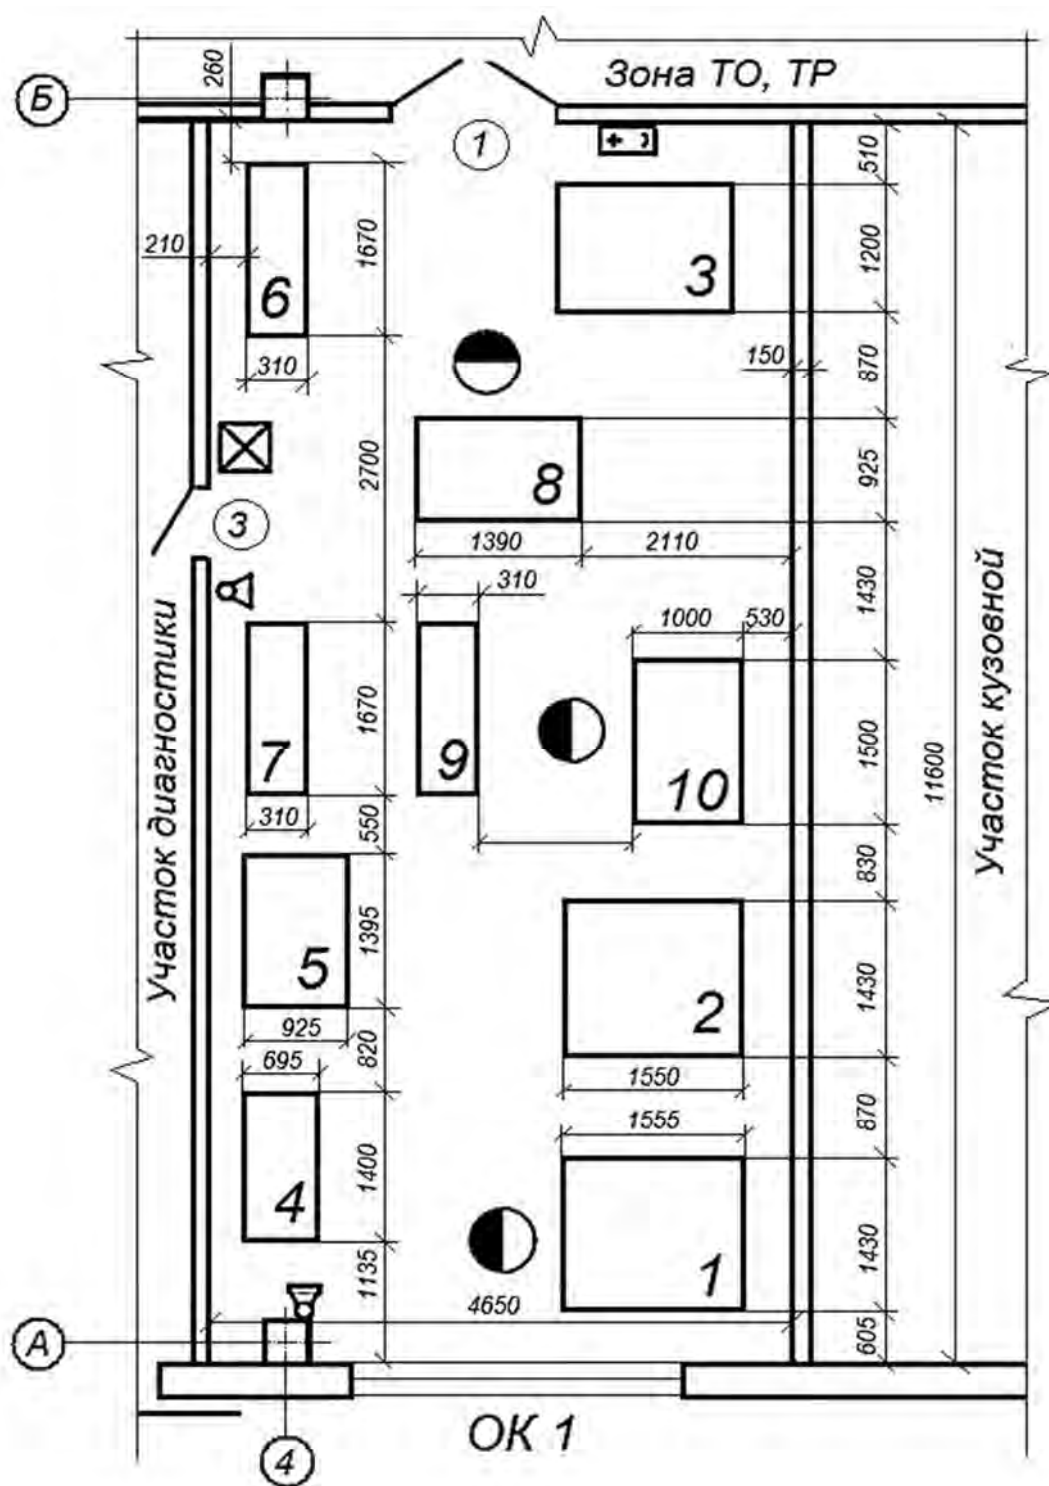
Планировочное решение кузнечно-рессорного участка: 1 – пневматический ковочный молот; 2 – стеллаж для рессорных листов; 3 – подставка для деталей; 4 – верстак для рессорщика на чугунных ножках; 5 – стенд для сборки-разборки рессор; 6 – ванна нейтрализационная; 7 – ванна промывочная; 8 – стенд для испытания рессор; 9 – стенд для рихтовки рессор; 10 – стол
